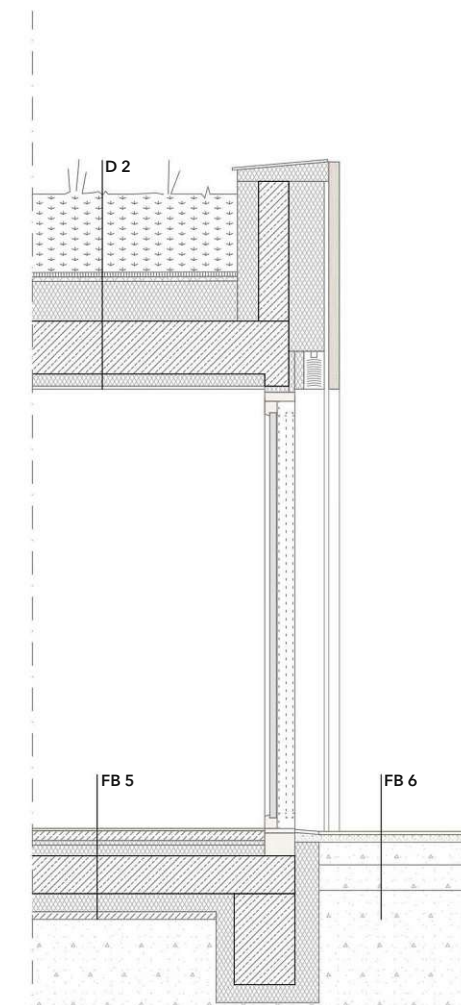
Fassadenschnitt 1:50 Hauptgebäude Kindergarten
